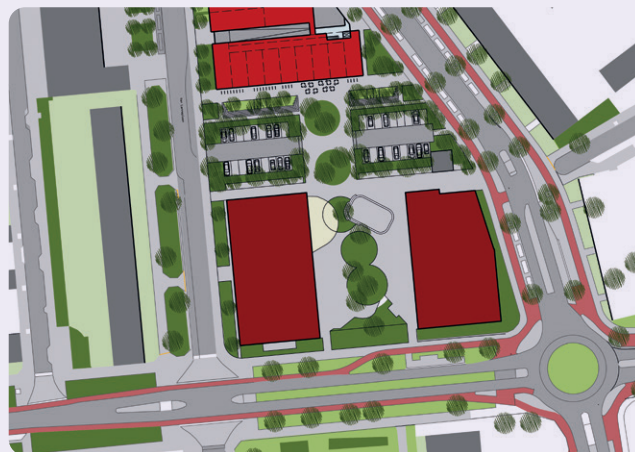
T-vormige openbare ruimte omkadering sub-core
